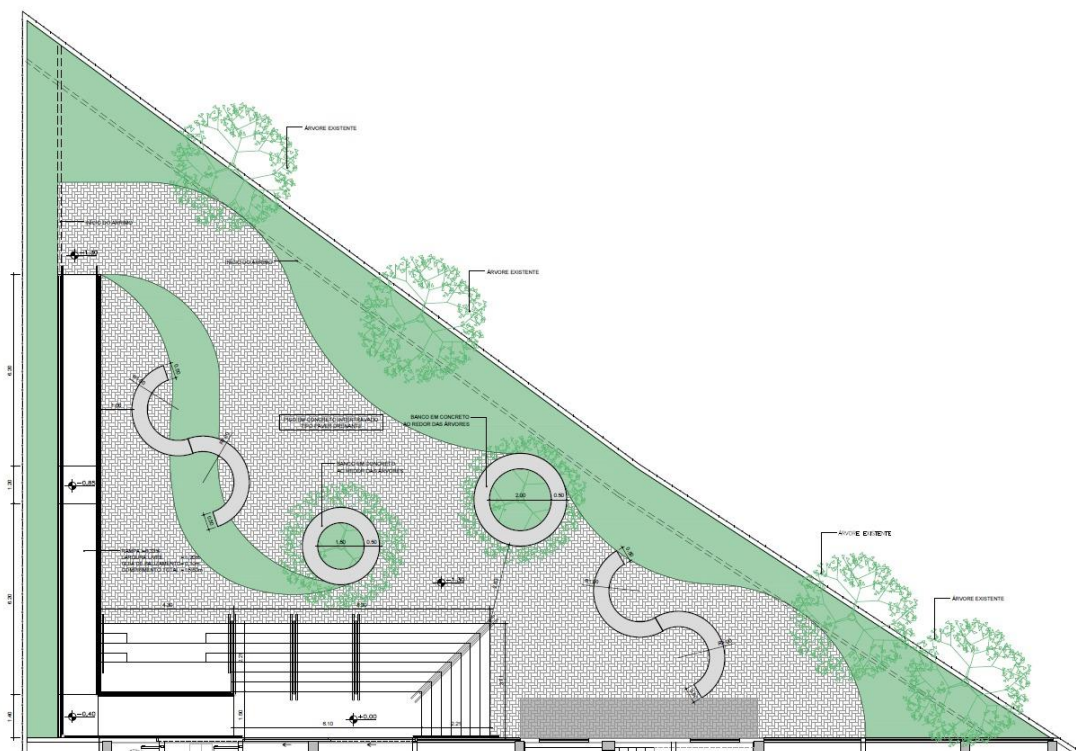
DETALHAMENTO DO PAISAGISMO.
